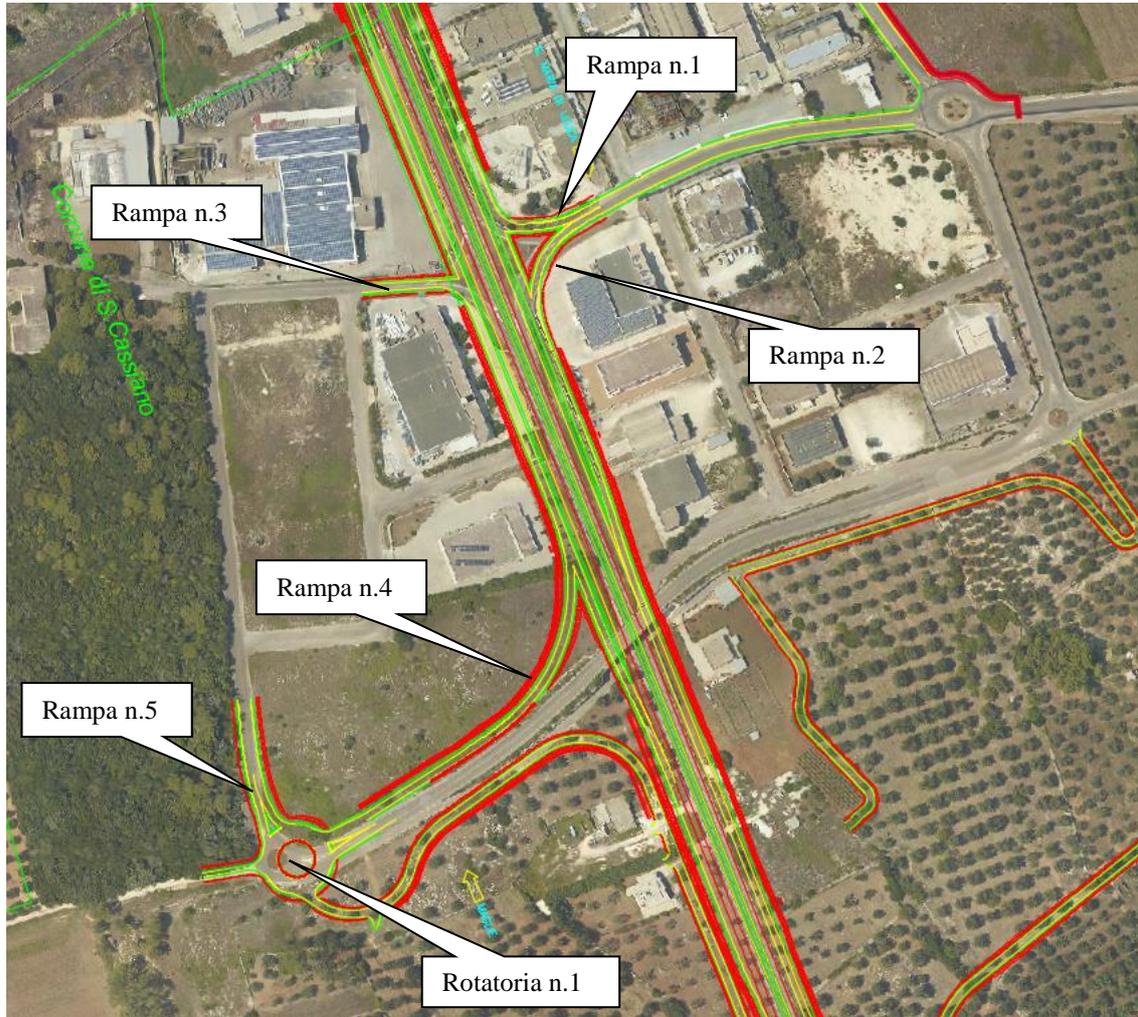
Svincolo 8 b – BOTRUGNO SUD – nuova configurazione di progetto
